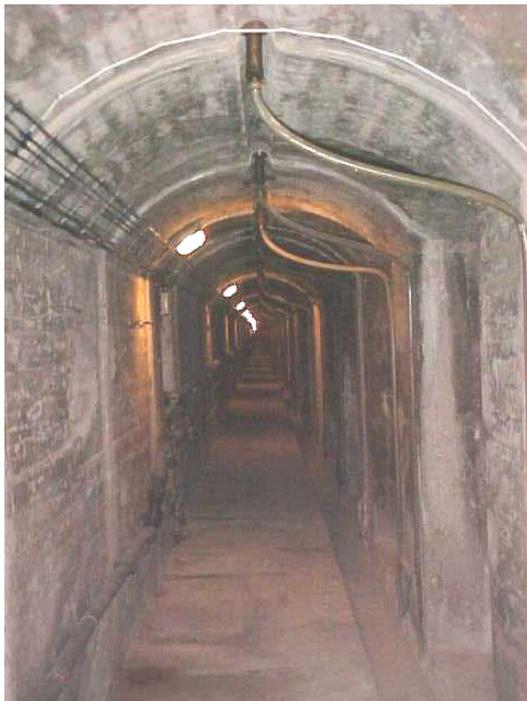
Drenes entre galerías en la presa de Guadalest
